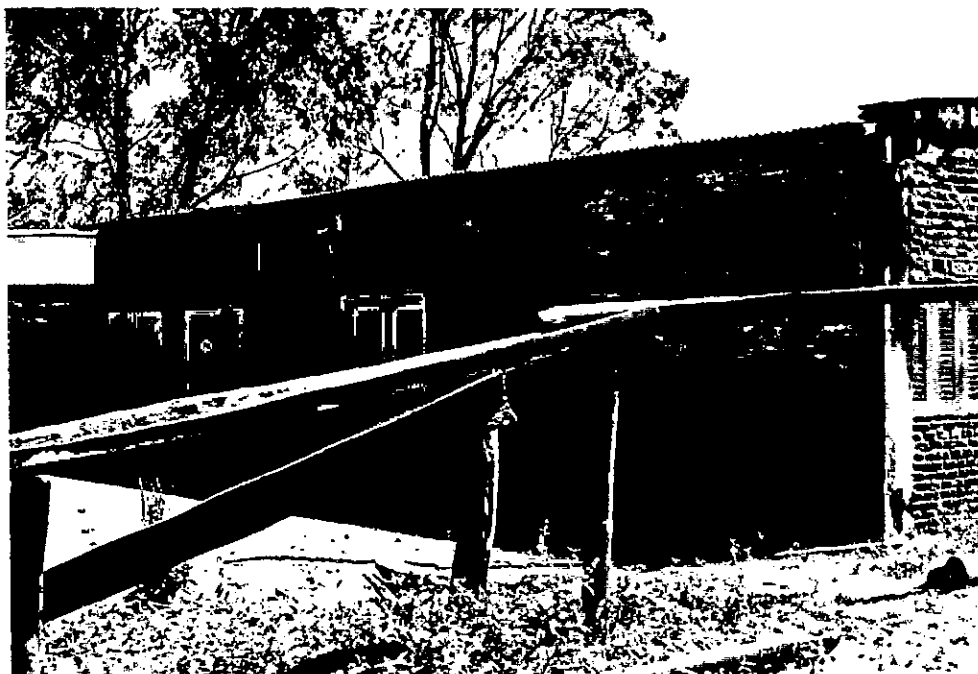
Escuela N° 262. Se colocarán las bajadas, cámaras de limpieza y conexión con el aljibe, actualmente en estado precario.
